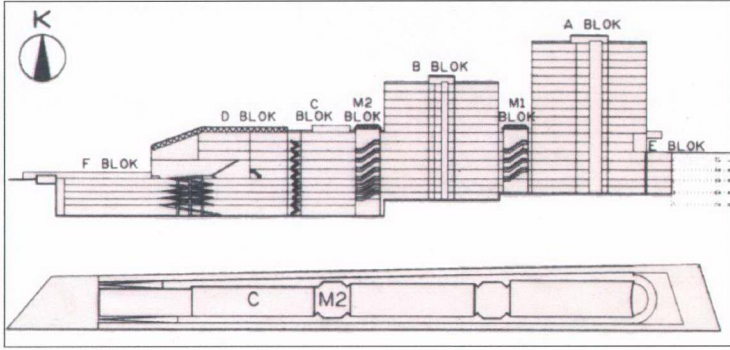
İş Bankası Genel Müdürlük Binası Cephe Detayı
